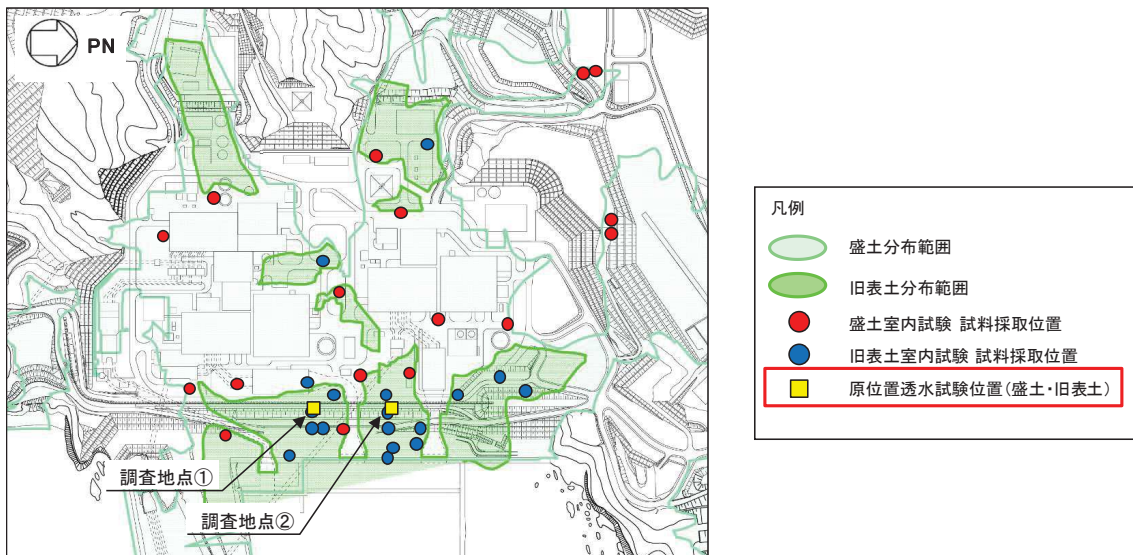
盛土・旧表土の原位置透水試験位置図 (平面図)
